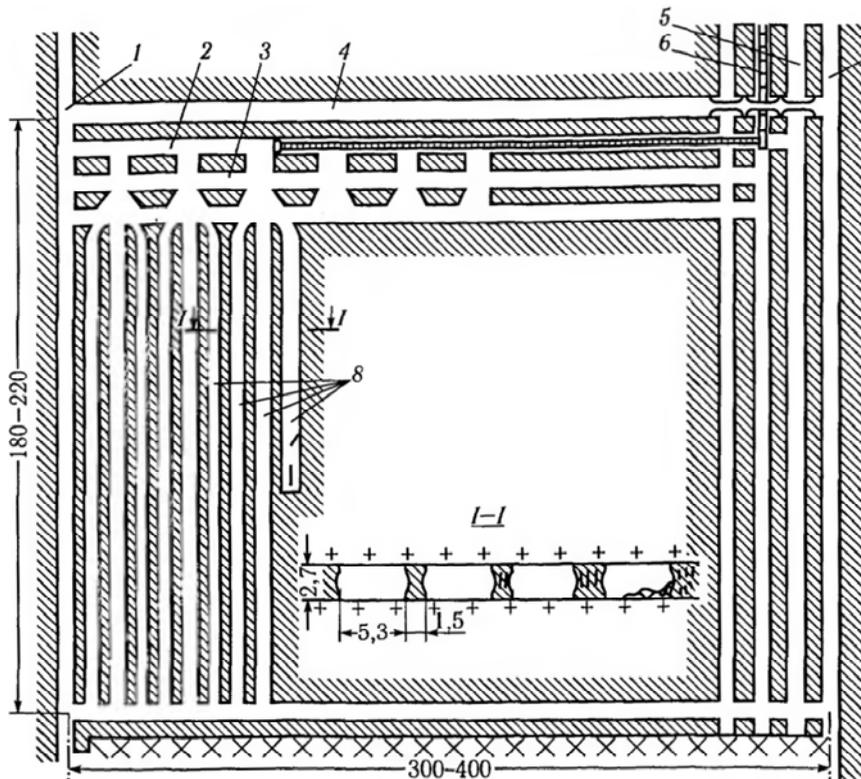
Камерная система разработки с плавной посадкой кровли на податливых (разрушаемых) целиках:
